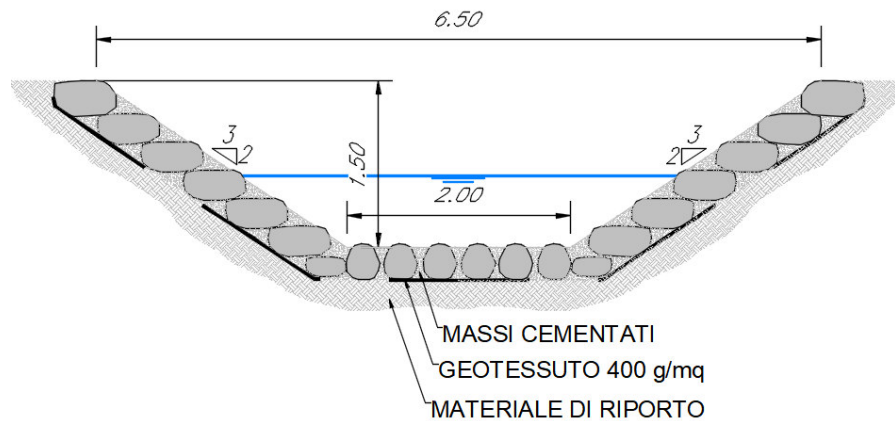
Corso d'acqua IN09_ Sezione tipo sistemazione
